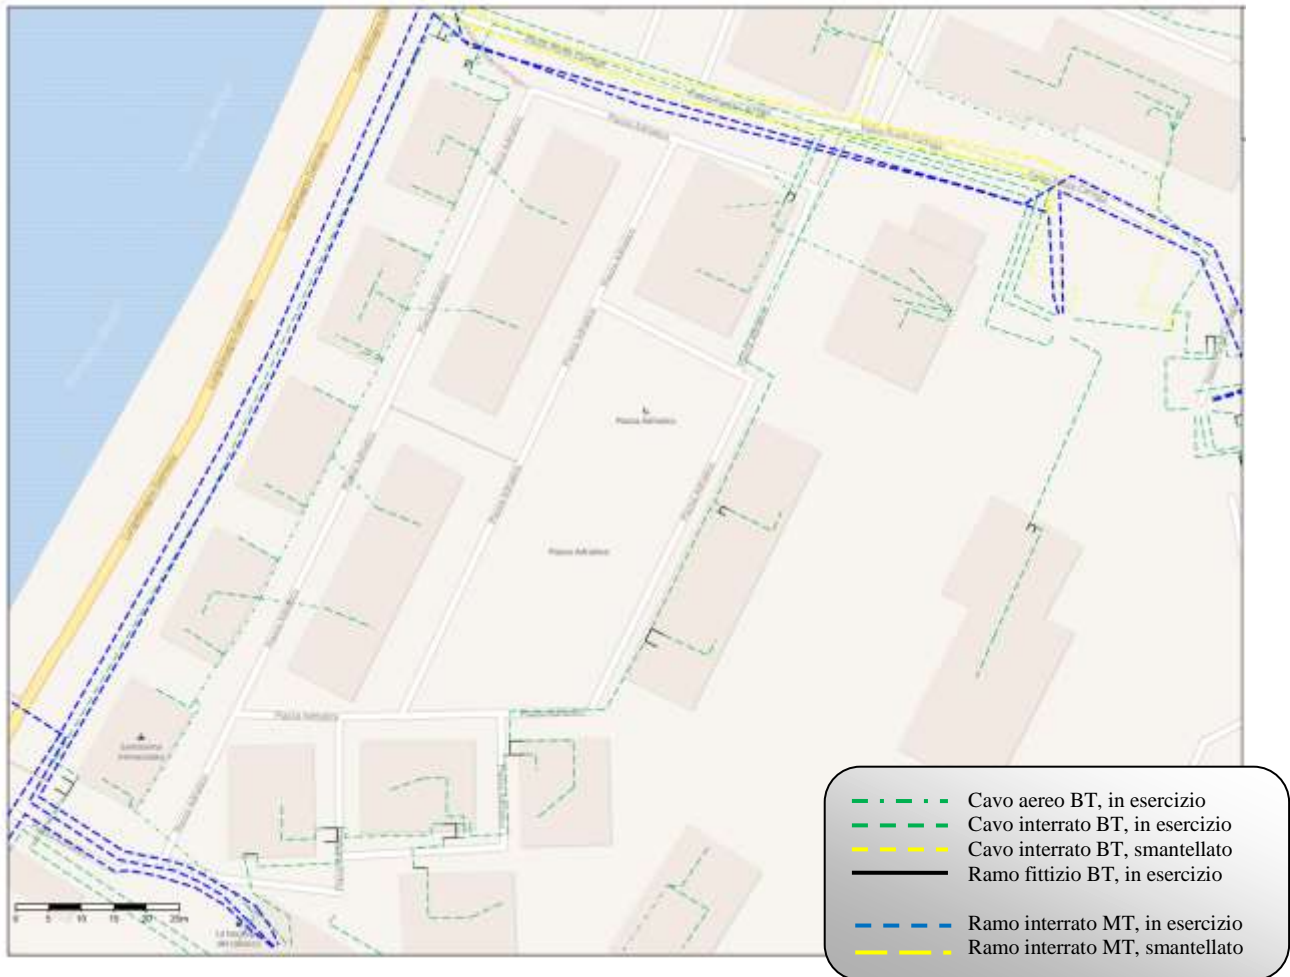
Stralcio planimetrico dell'impianto E-Distribuzione esistente
